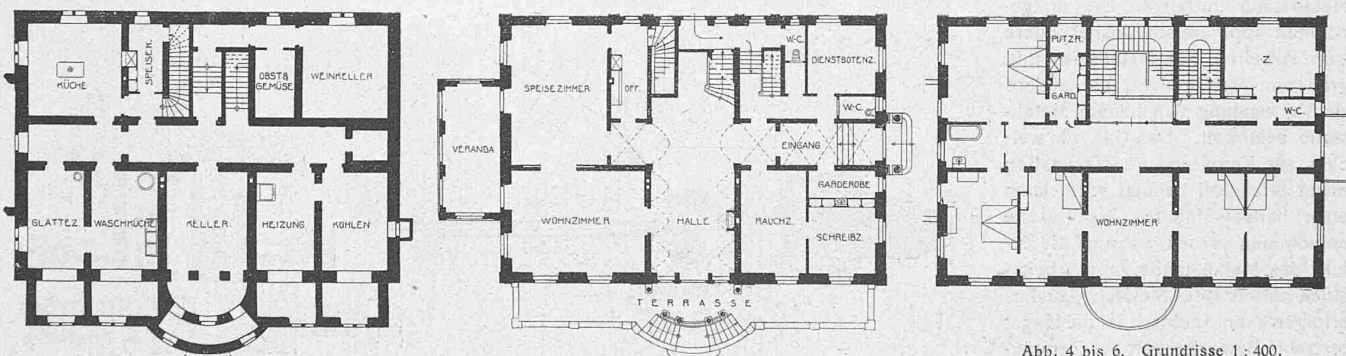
bis 6. Grundrisse 1:400.
